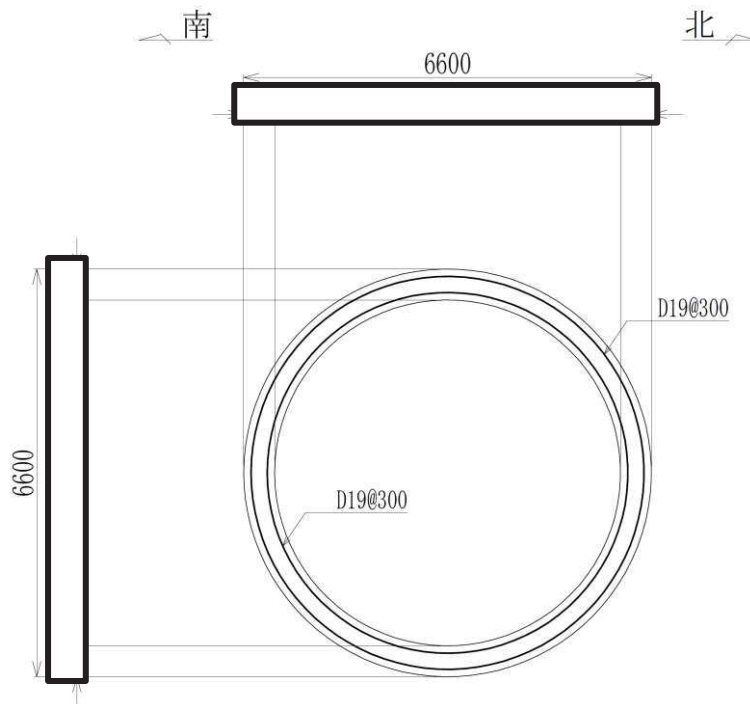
排気筒連絡ダクト概略配筋図 (B-B 断面, 岩盤部)
